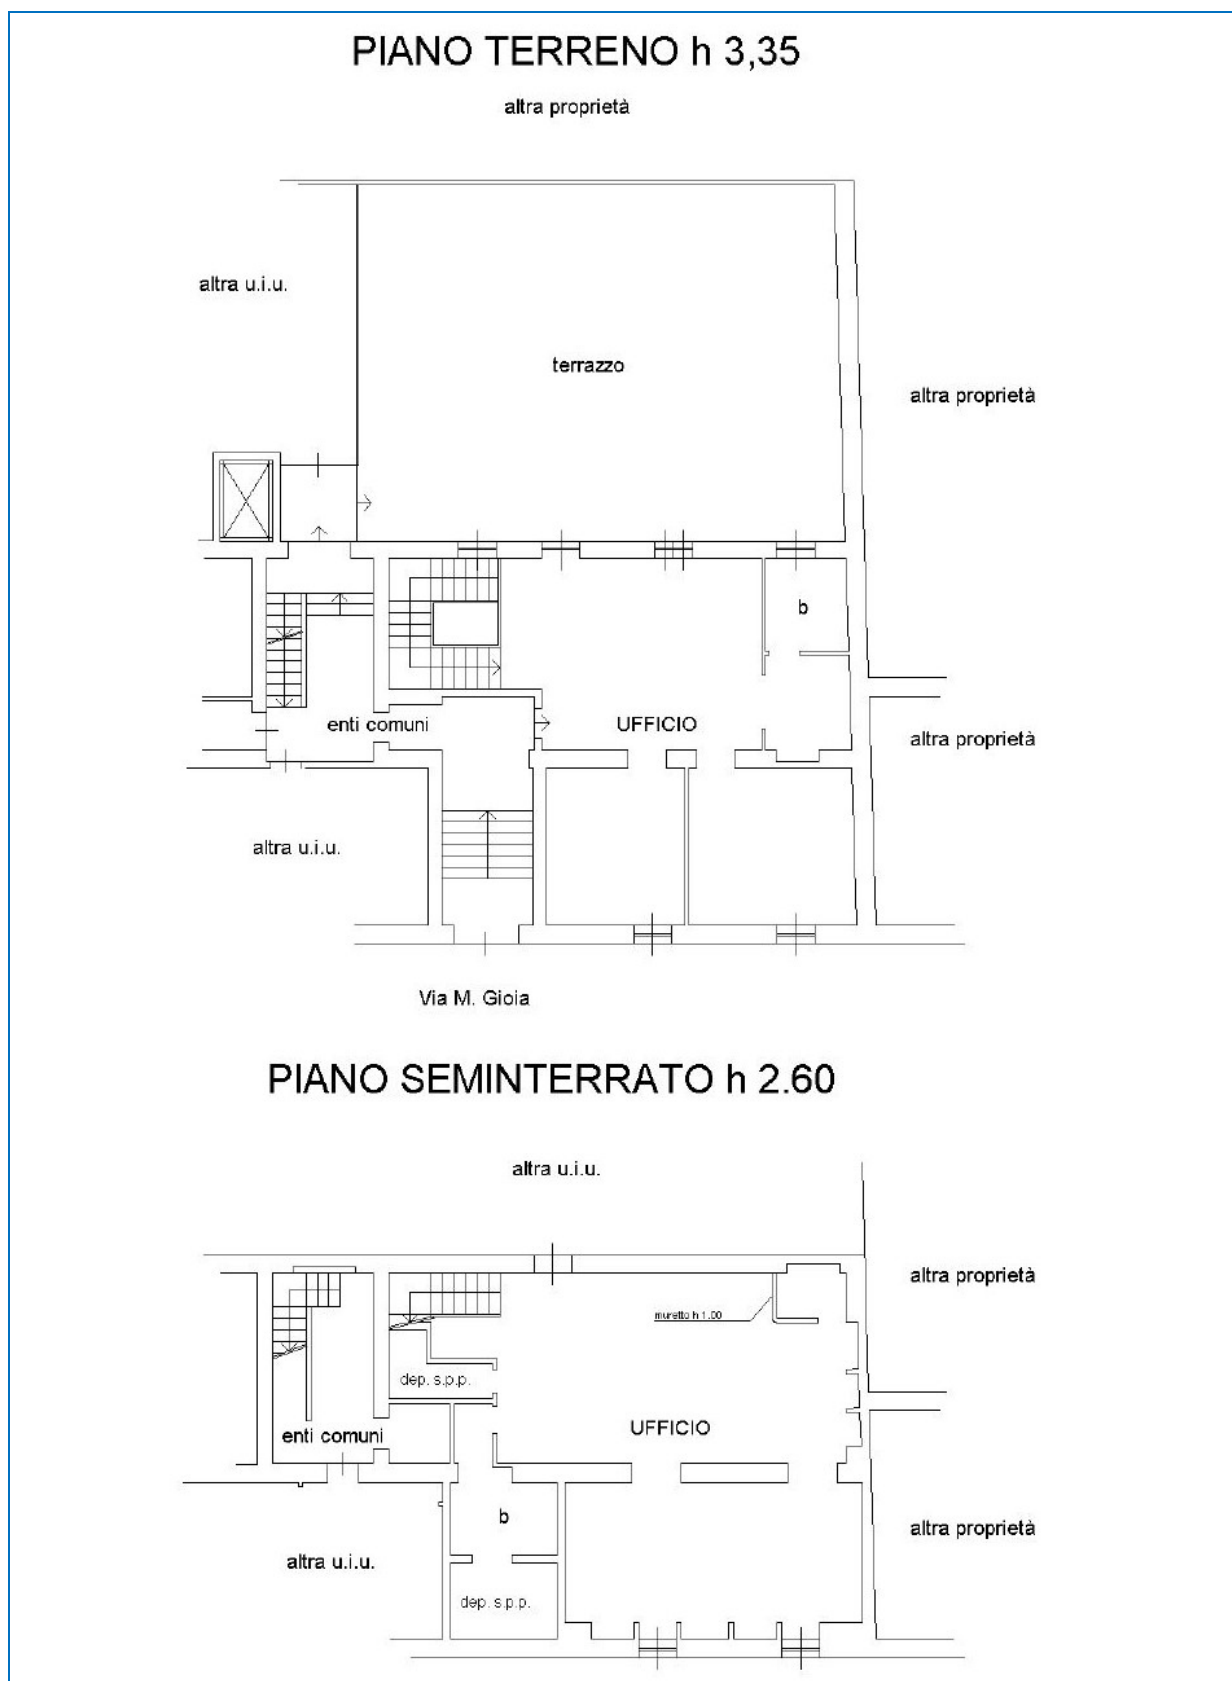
estratto planimetria catastale dell'ufficio sub. 731
